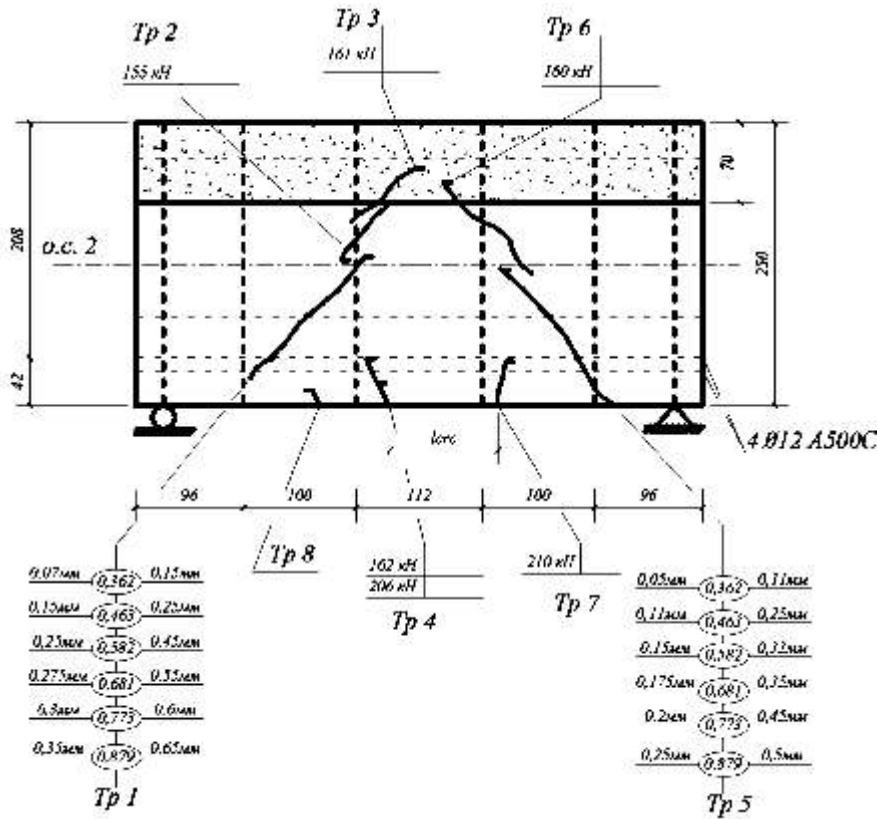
Картины развития и раскрытия трещин в балке-стенке шестой серии VIBС30-20 (в овале указано отношение текущей нагрузки к разрушающей; слева – ширина раскрытия трещин)
